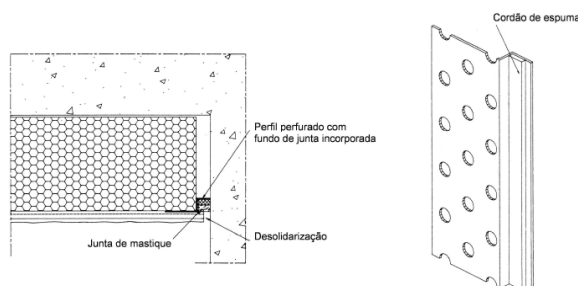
Ligação do sistema com elementos da fachada [7]
